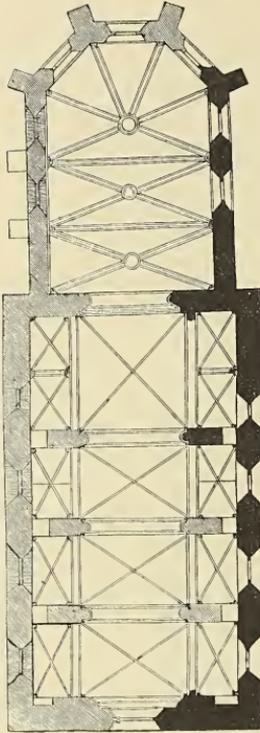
Grundriss der Pauliner-Kirche von Túskevár (Jenő, Torna).
